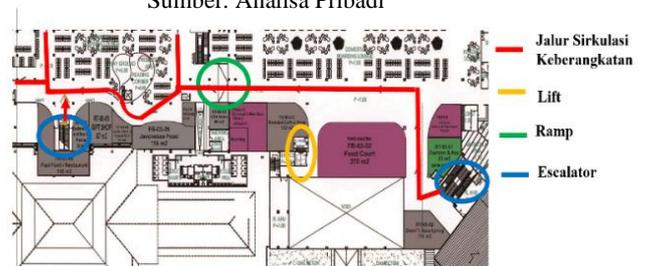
Denah lantai 1 Bandar Udara Adi Soemarmo
